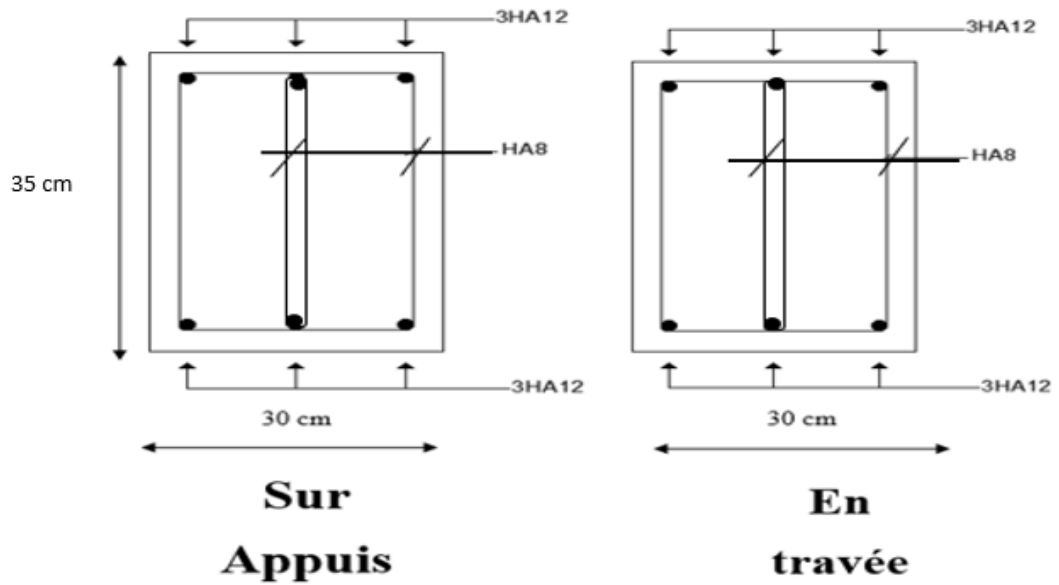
Schémas de ferrailage des poutres secondaires en appuis et travée (Terrasse)
